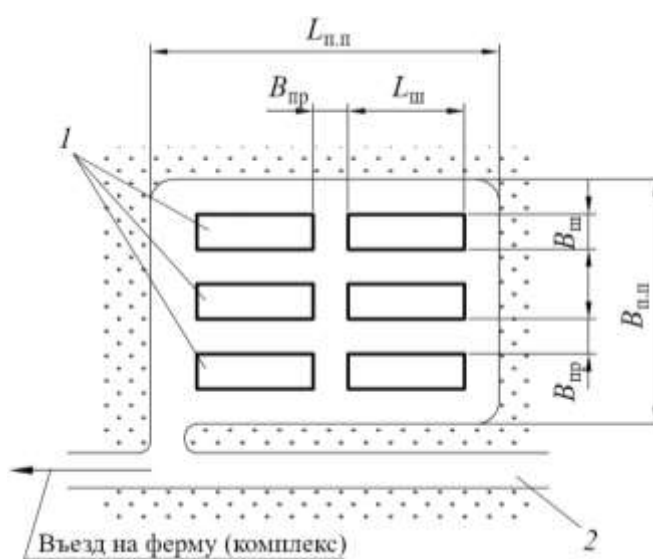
Схема к определению размеров площадки для хранения подстилочного материала:
